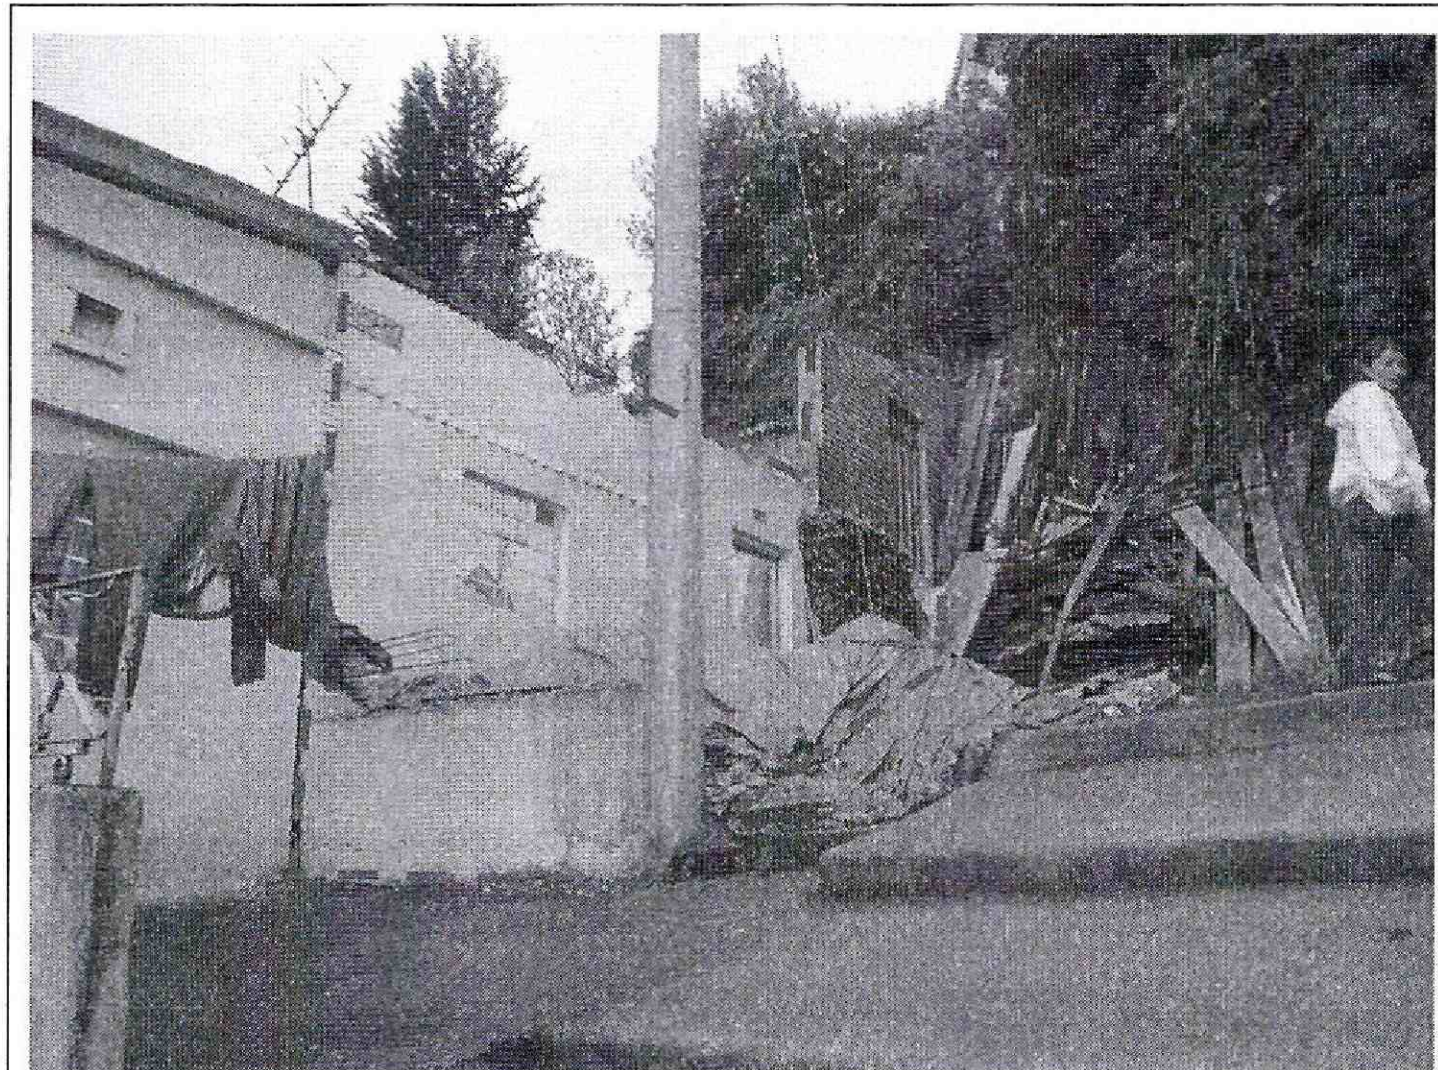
Vista del predio de la Calle 36J Sur # 9-84 Este, evidencia de que el mismo corresponde a un lote vacío con algunos vestigios de una preexistente
